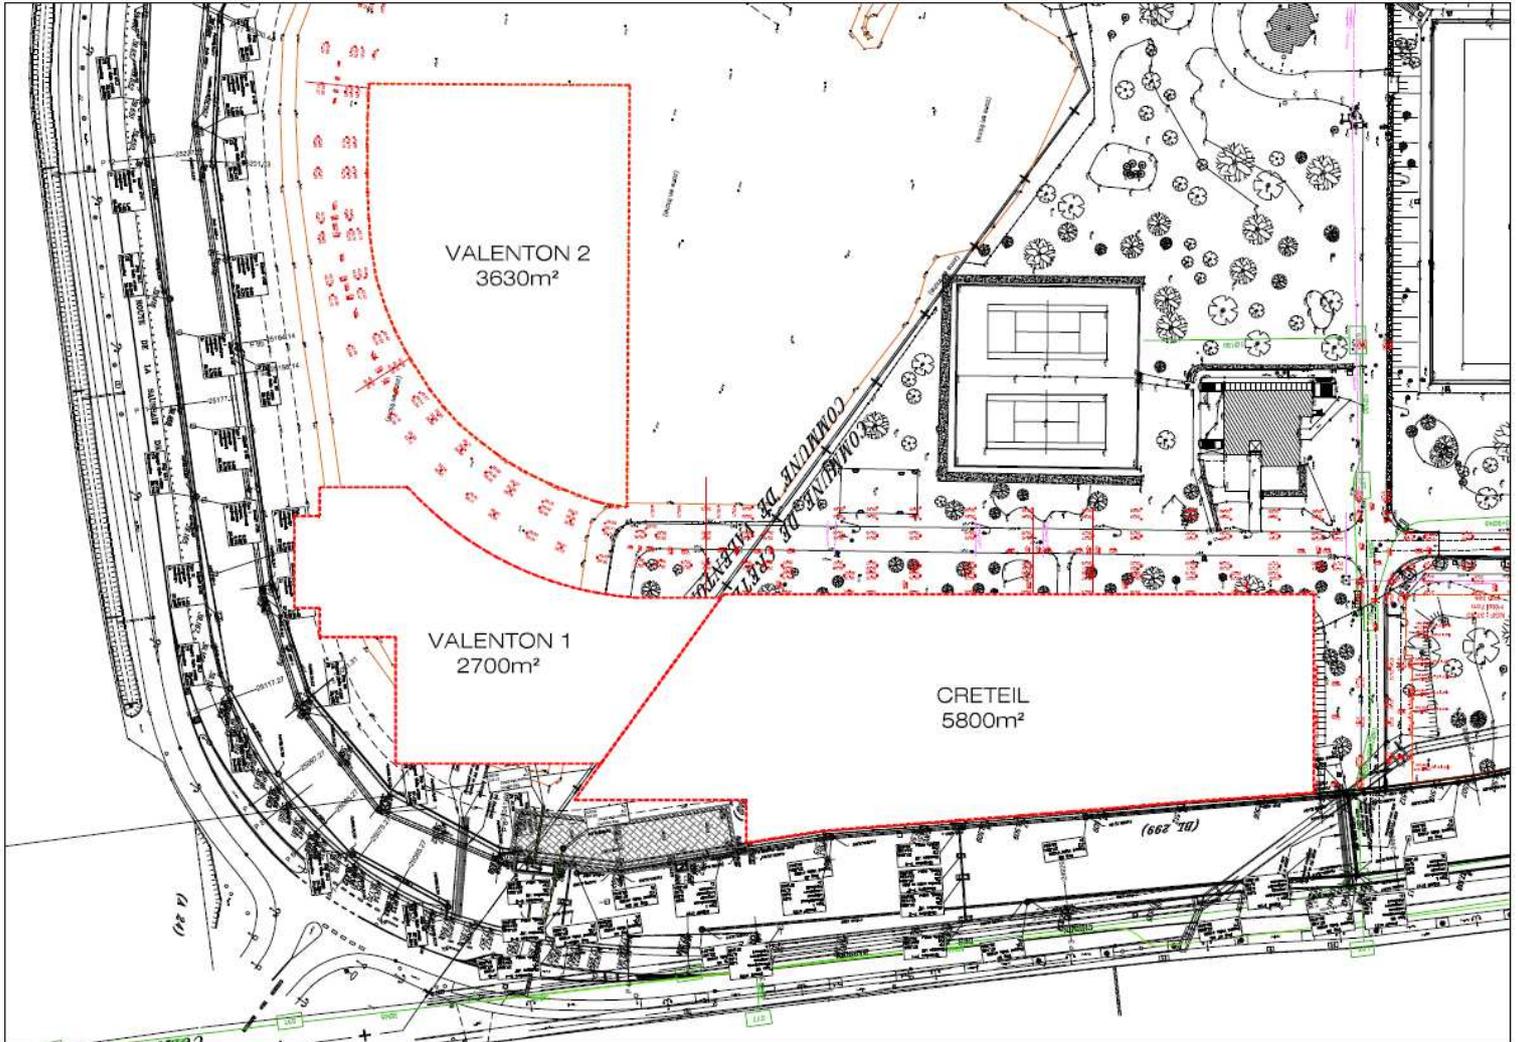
Plan masse des deux hôtels (îlot Nord du site – coté station « Pointe du Lac »)
